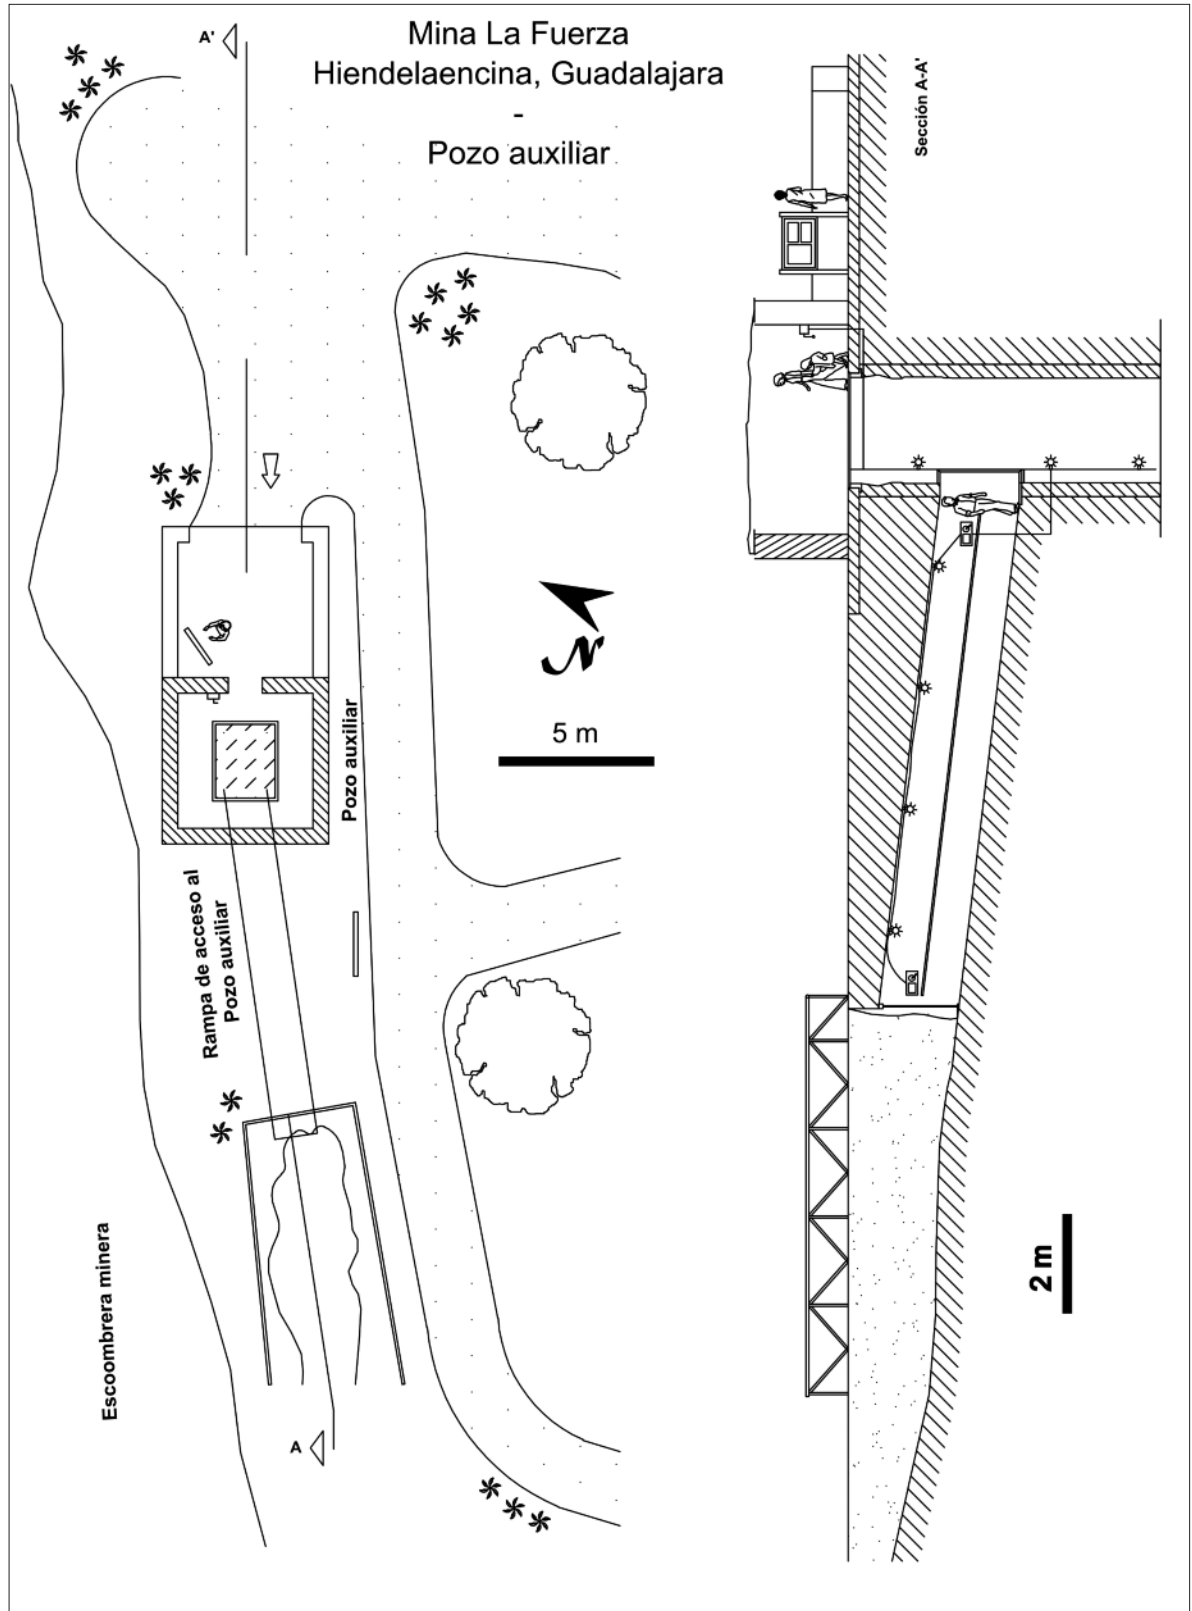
Planta y sección del pozo secundario de la mina La Fuerza, tras la rehabilitación de las ruinas, y las actuaciones para permitir observar el pozo minero desde la superficie y a través de la galería de acceso.
